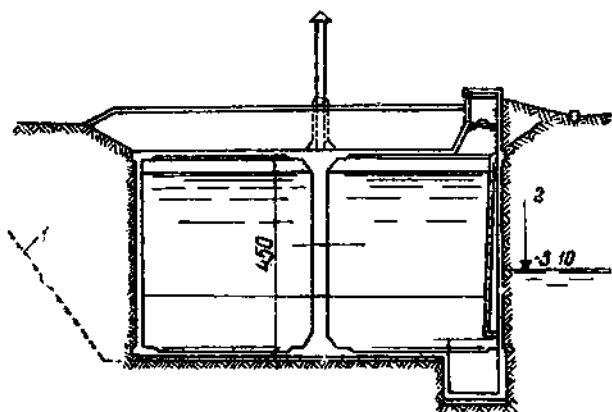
Железобетонный резервуар на 250 м^3 для сырых грунтов
